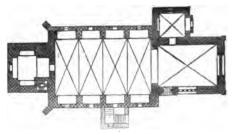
Vilmnitz. Kirche. Grundriss. 1:667.
